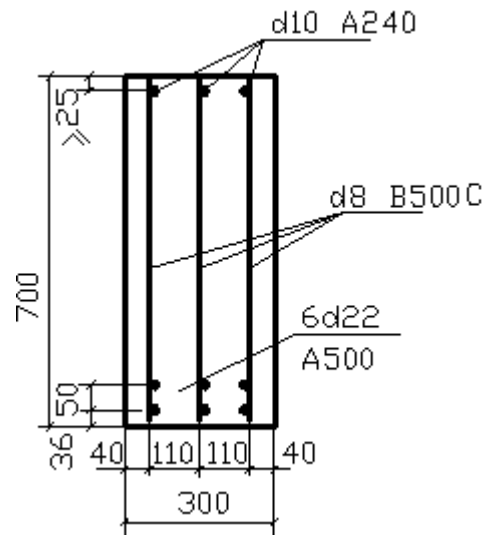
Армирование ригеля после изменения в результате расчета по раскрытию трещин
